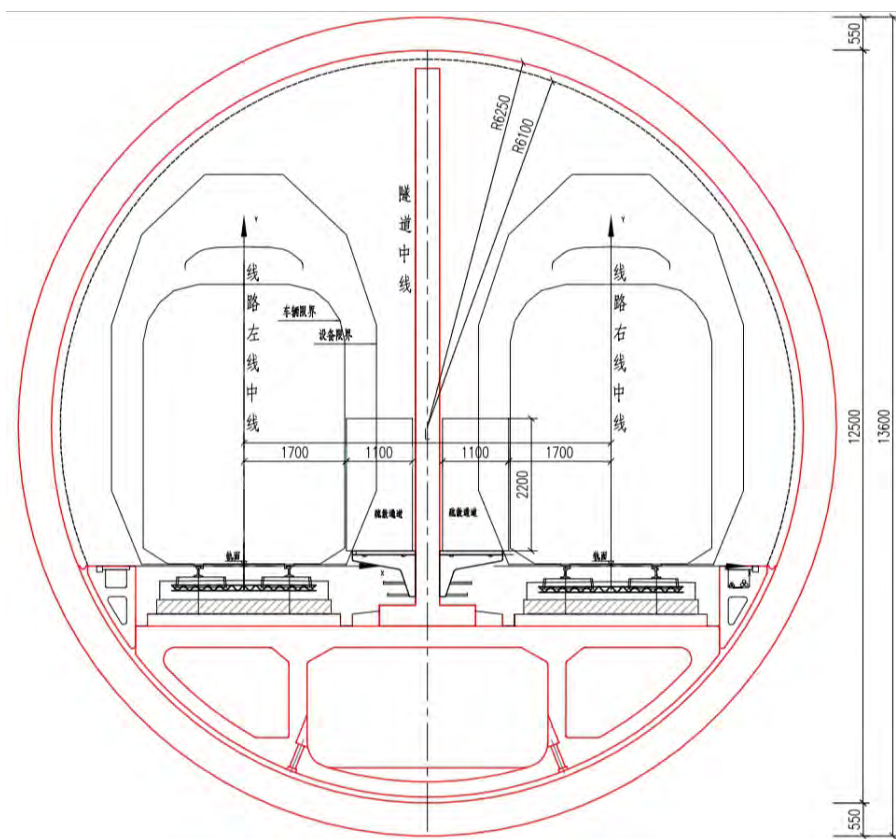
单洞双线盾构法隧道横断面图布置图（Φ13.6m）
